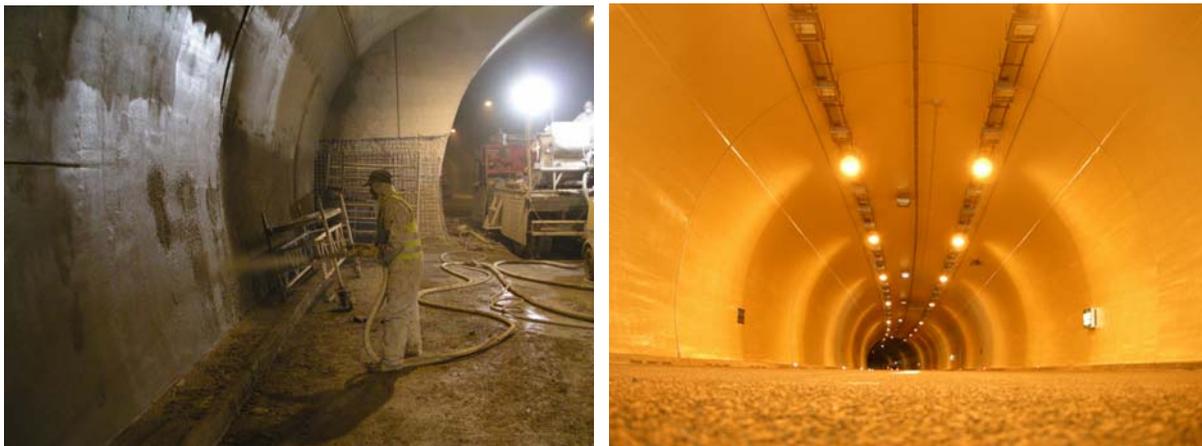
+7: Spritzbeton/Tunnelanstrich Ulmbereich Südröhre BA1, 11/07 (Bild: ARGE)
